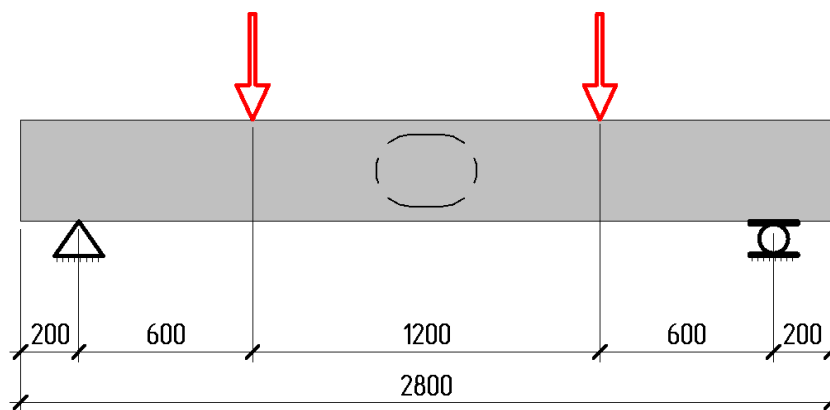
Схема испытаний железобетонной балки с петлевым стыком
